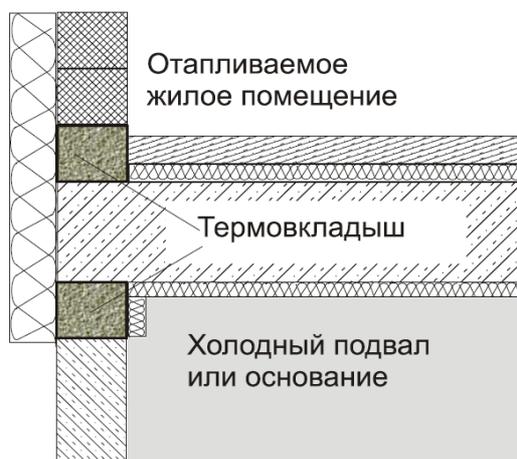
Схема утепления стыка между одноблочной наружной стеной и подвальным перекрытием [2]
